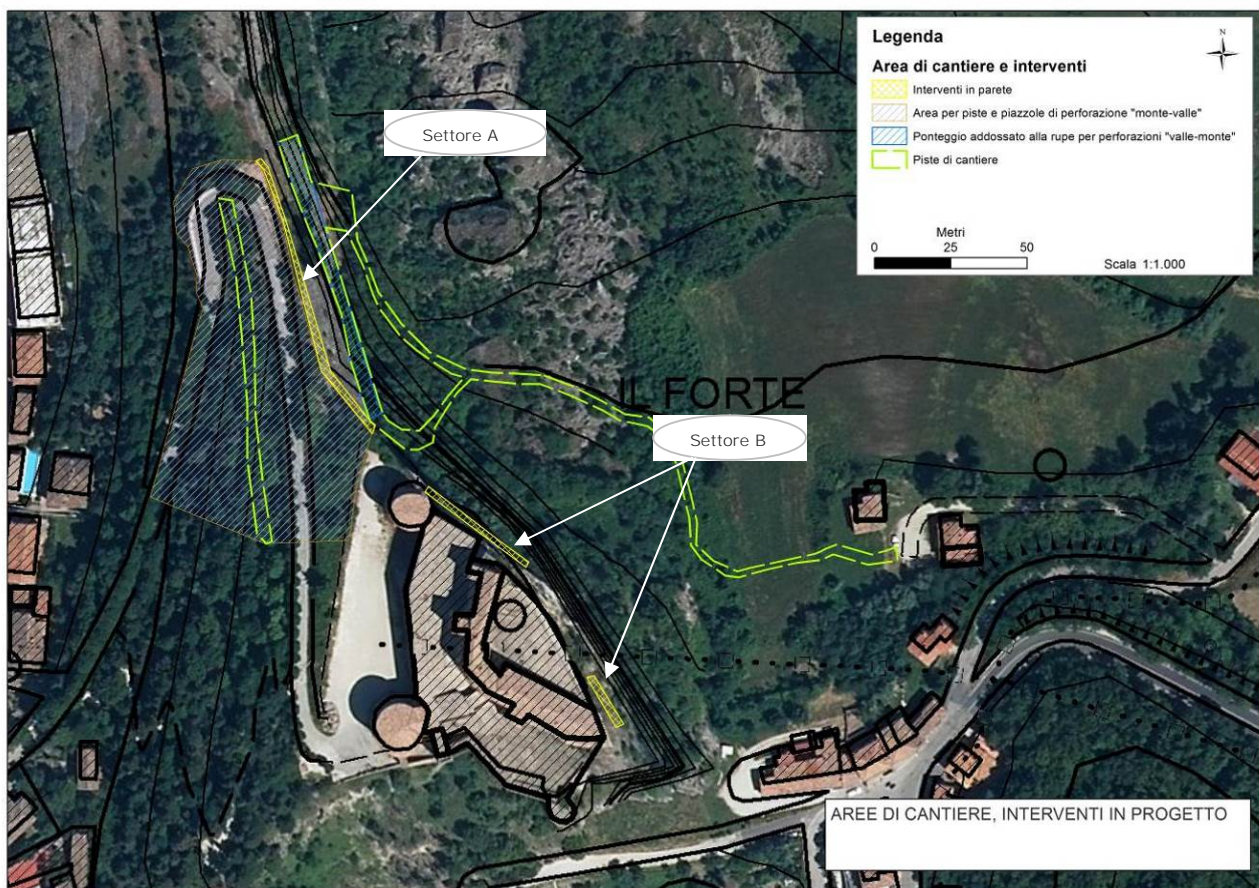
Aree di cantiere previste per la realizzazione delle opere in progetto
